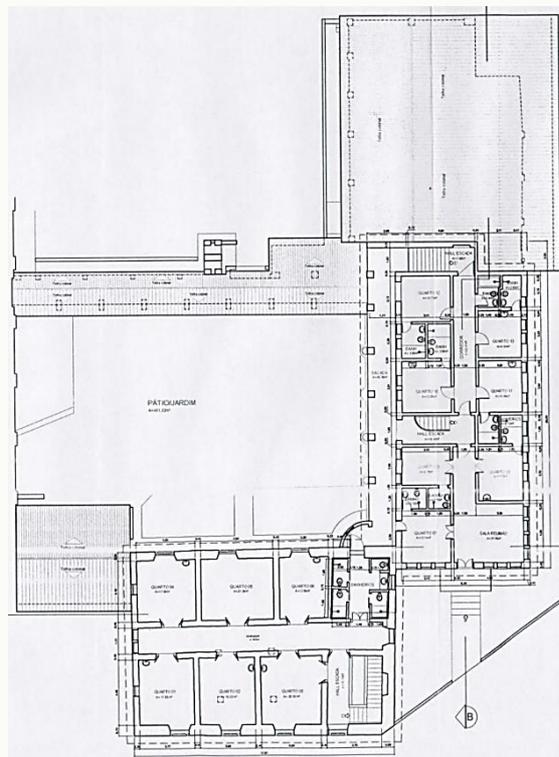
Planta-baixa (primeiro pavimento) do projeto de restauração do convento dos dominicanos, elaborado pelo IPHAN em 2007.
